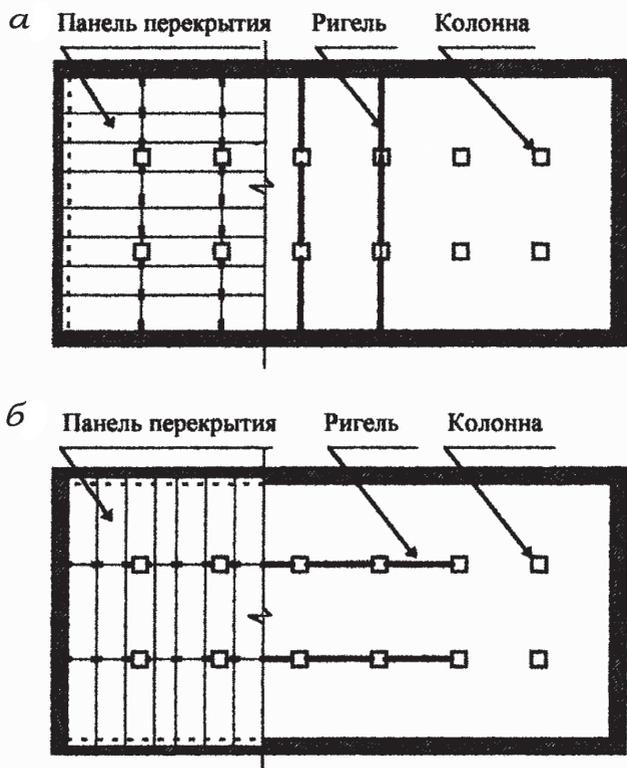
Схемы компоновки сборного перекрытия с поперечным (а) и про-дольным (б) расположением ригелей
